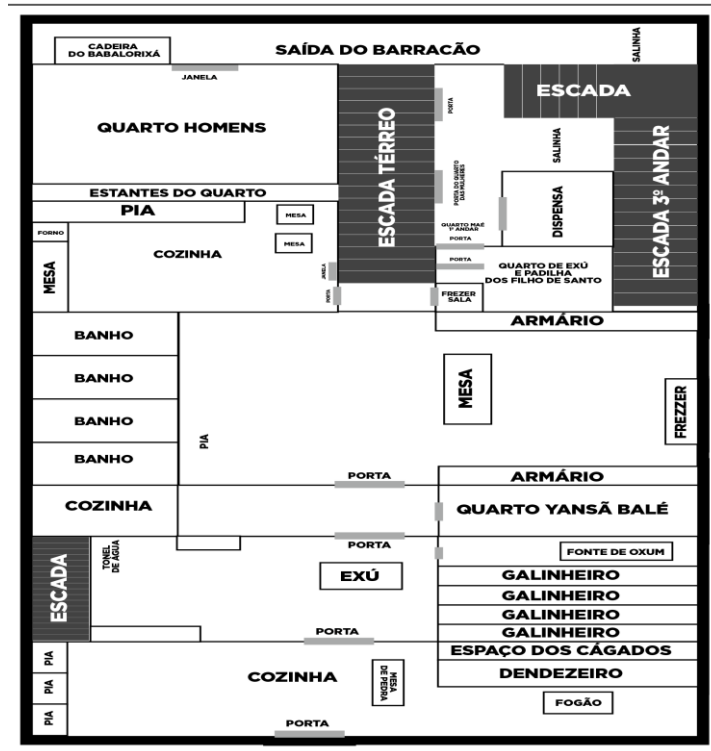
Planta do Terreiro – Estrutura após o Barracão até a estrutura final do terreiro
